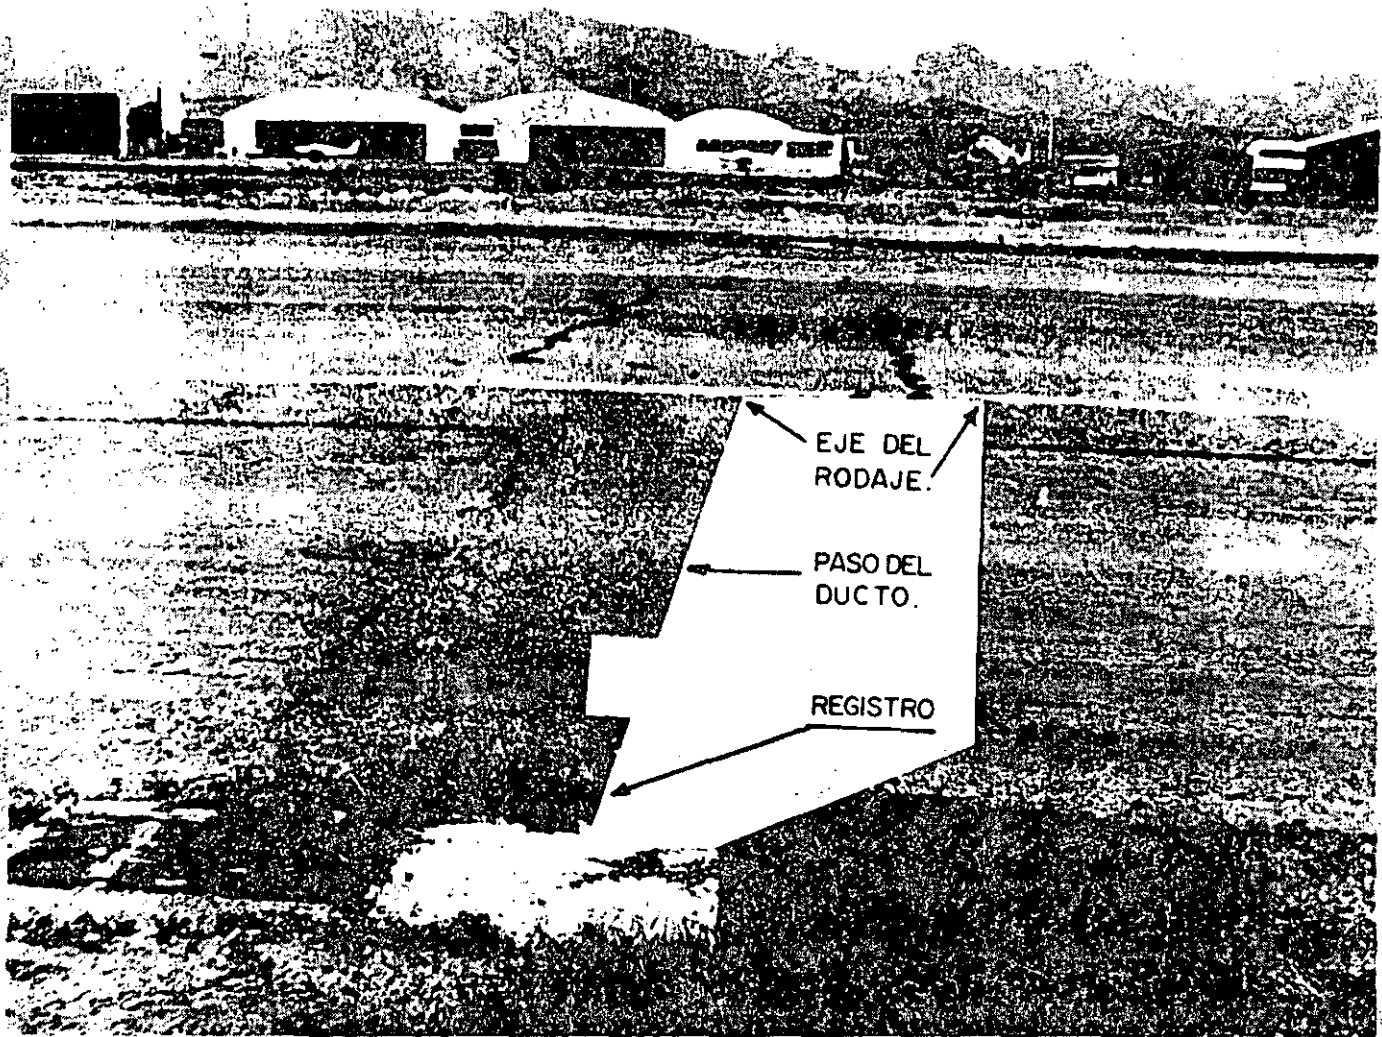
Grietas transversales en la zona de pavimento cruzada por un ducto.
